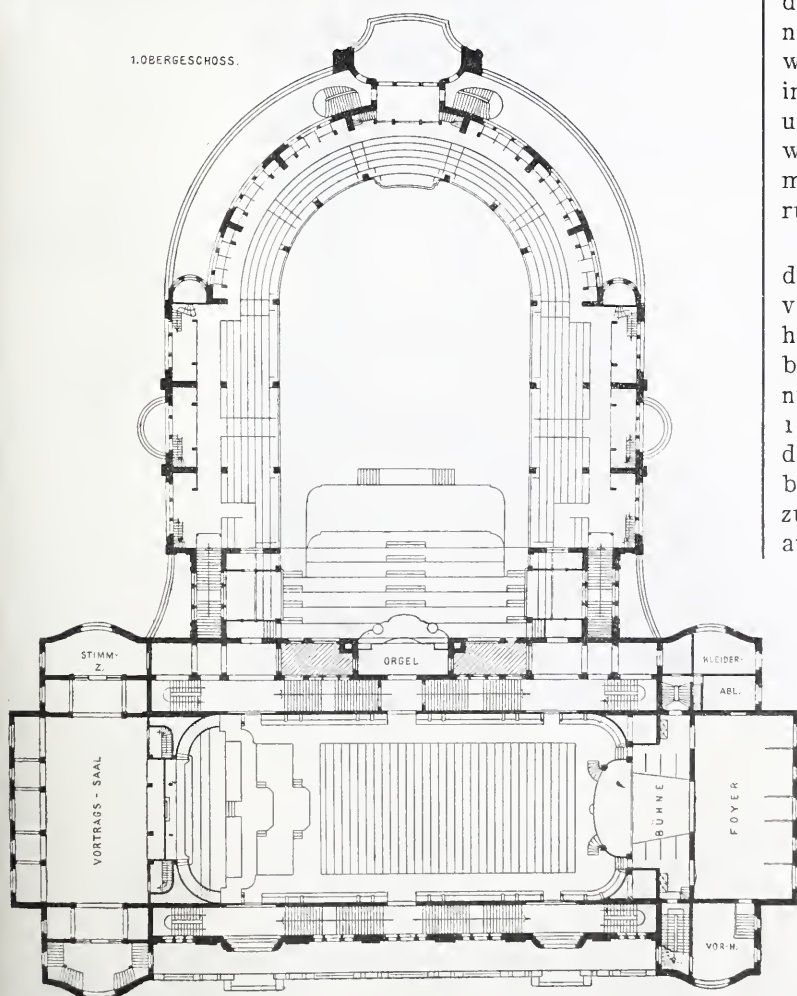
Grundriss vom I. Obergeschoss.
